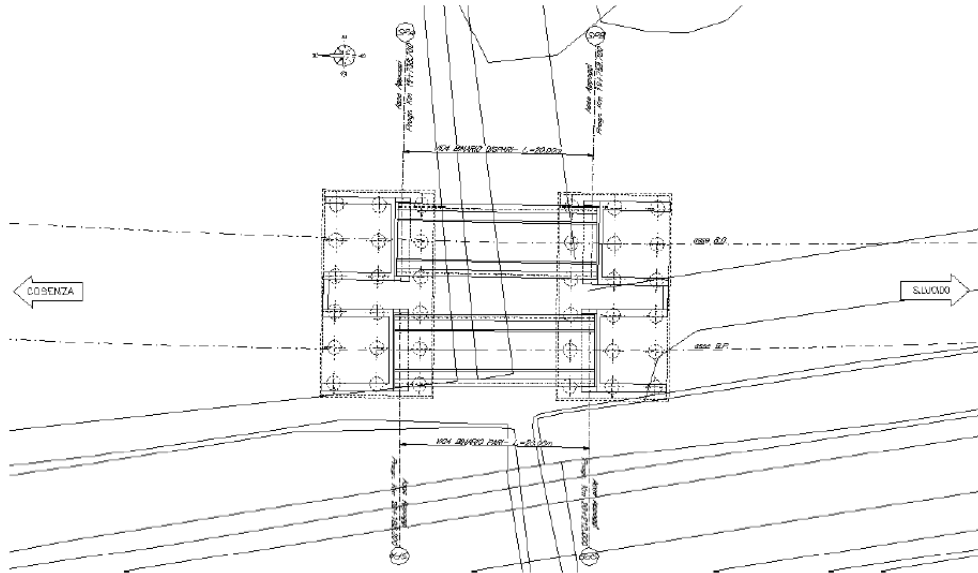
Planimetria dei viadotti ferroviari VI04a e VI04b
